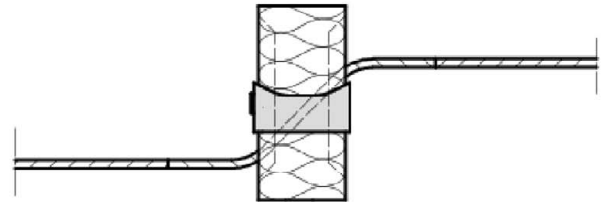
Schöck Isokorb® Typ Q-ID mit Betondrucklager
